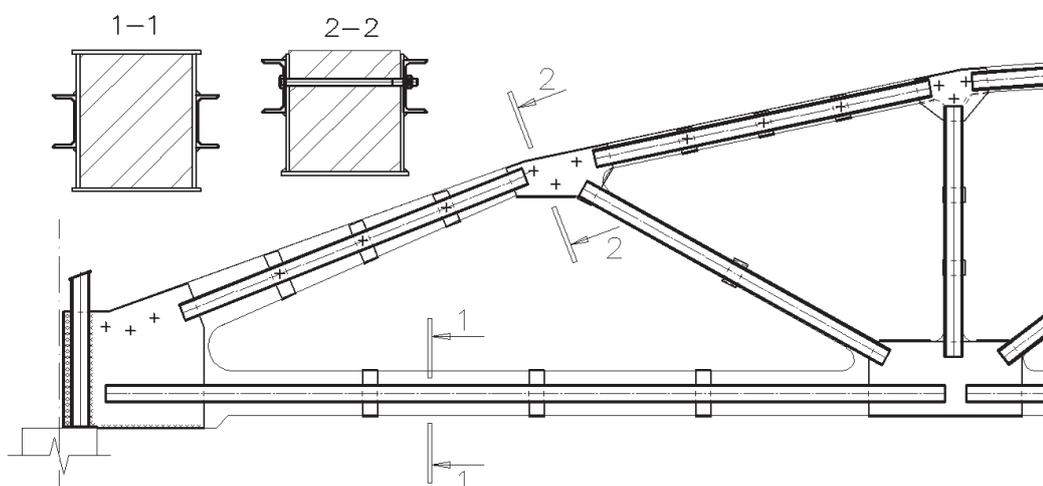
Схема усиления железобетонных сегментных ферм покрытий – увеличение сечения введением стальных швеллеров с листовым обхватом и пластин в узлах со стяжными шпильками
